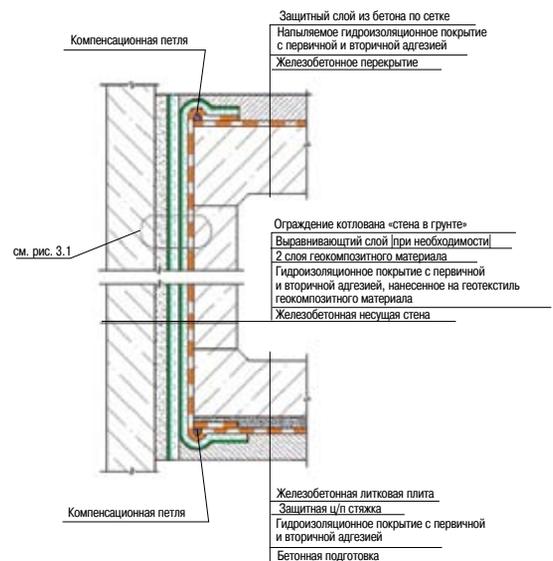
Схема устройства гидроизоляционной системы при открытом способе работ без пазух для обратной засыпки грунтом
